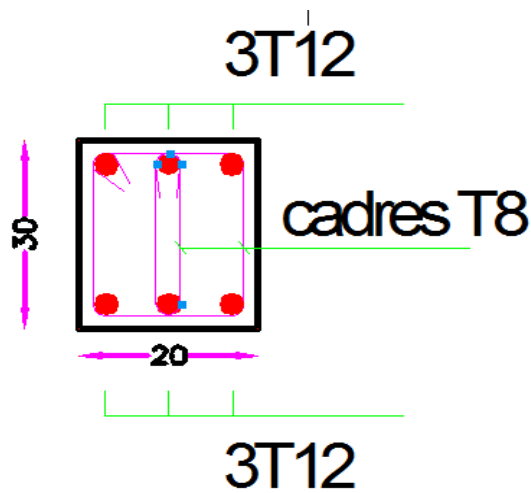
Ferraillage des poutres secondaire proche de voile
